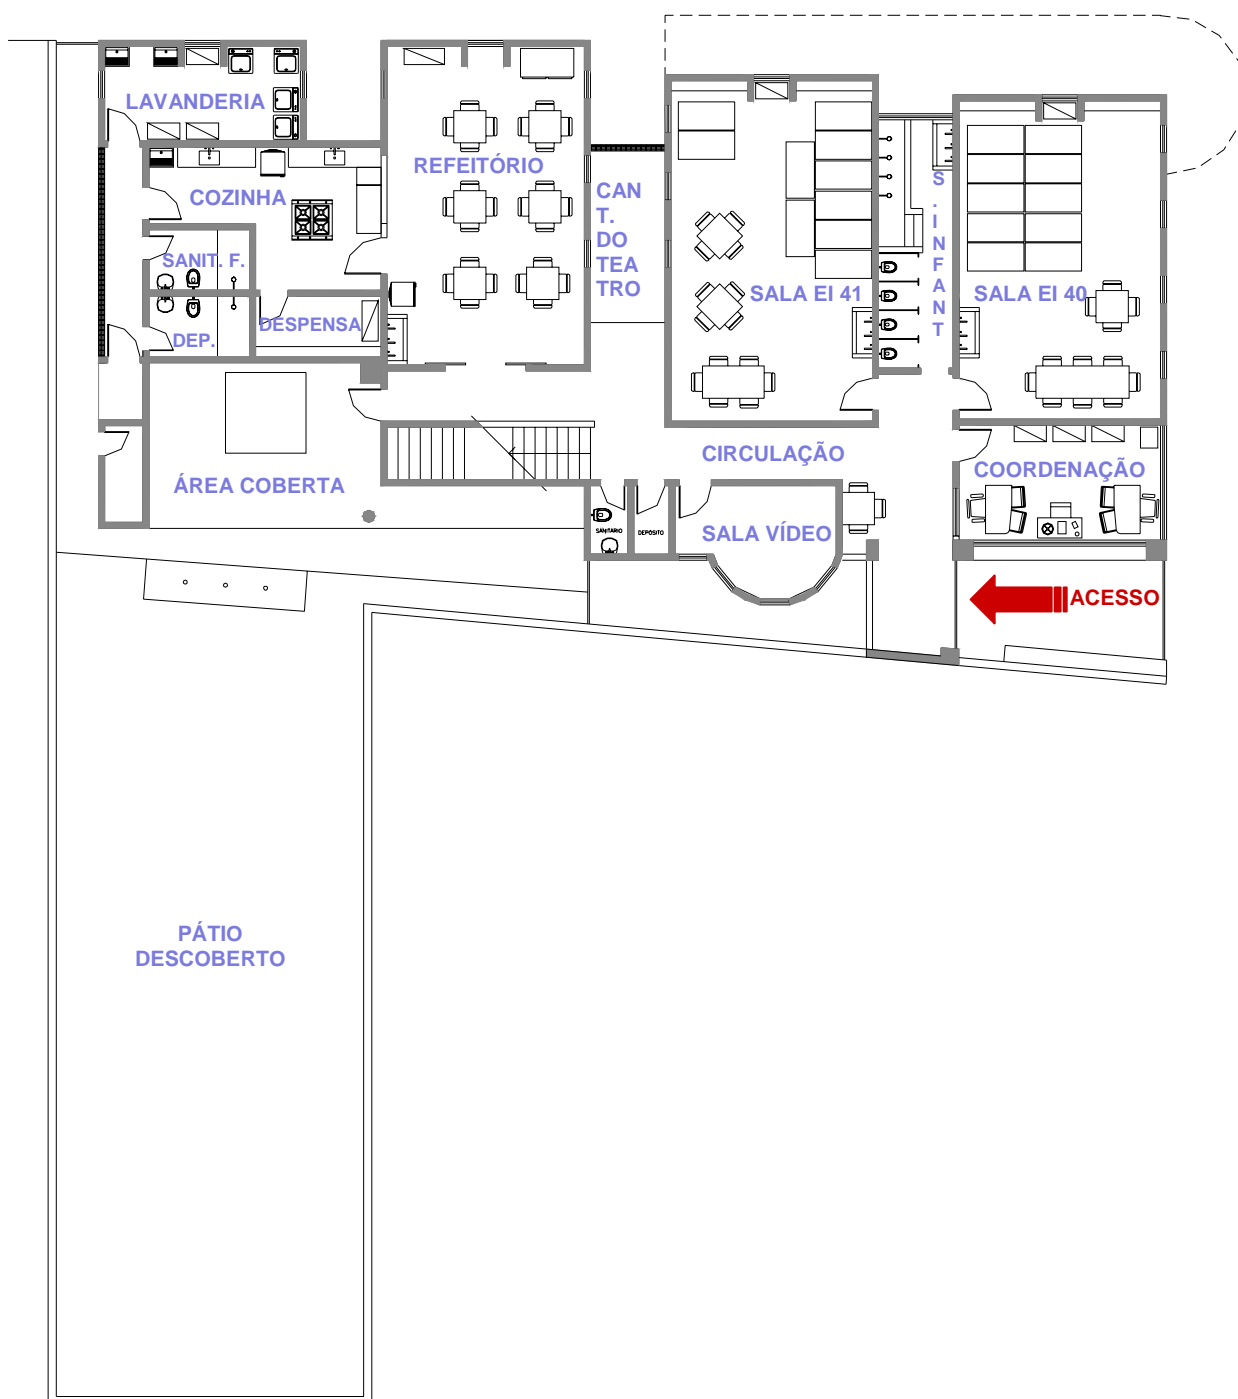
Planta baixa do 1º Pavimento da Creche
